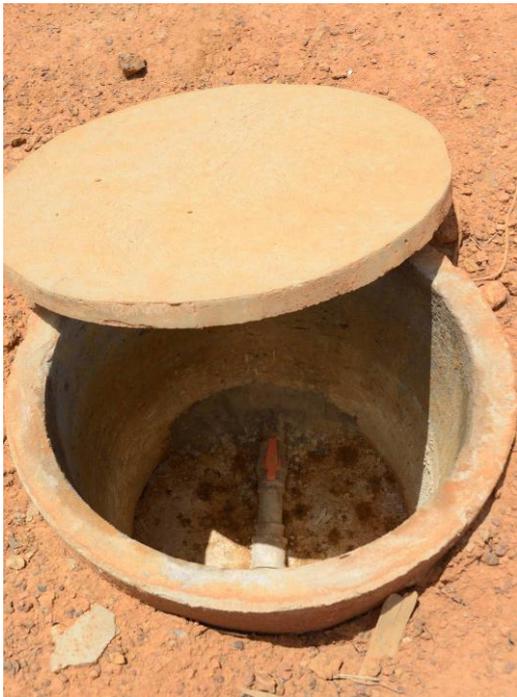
Estrutura componente do sistema de abastecimento de água na localidade Vila da Ressaca
